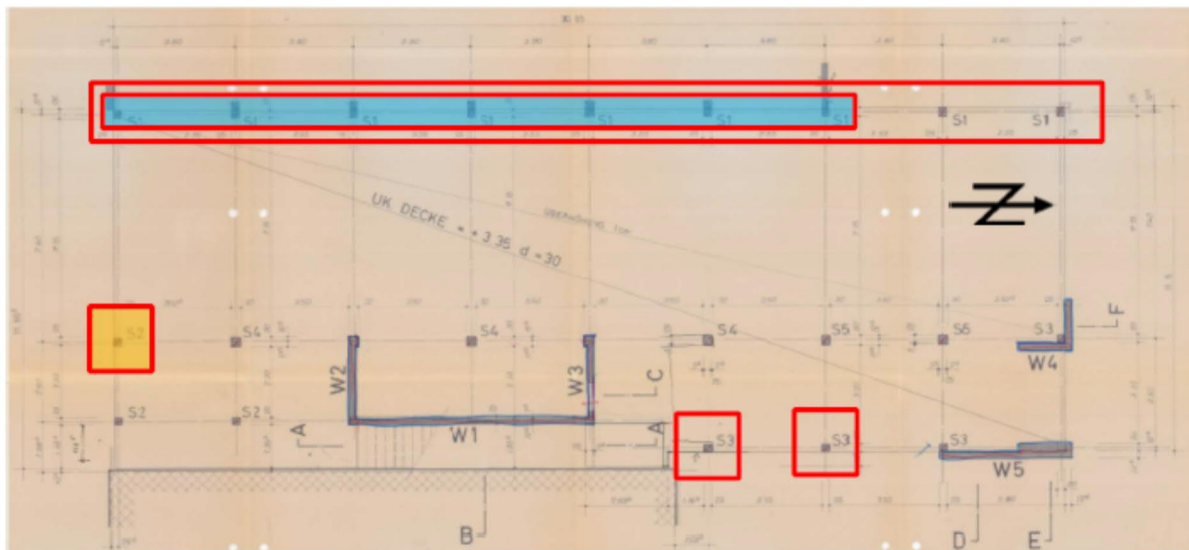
Plan horizontal du rez-de-chaussée. La résistance au poinçonnement des piliers marqués n'est pas garantie.
